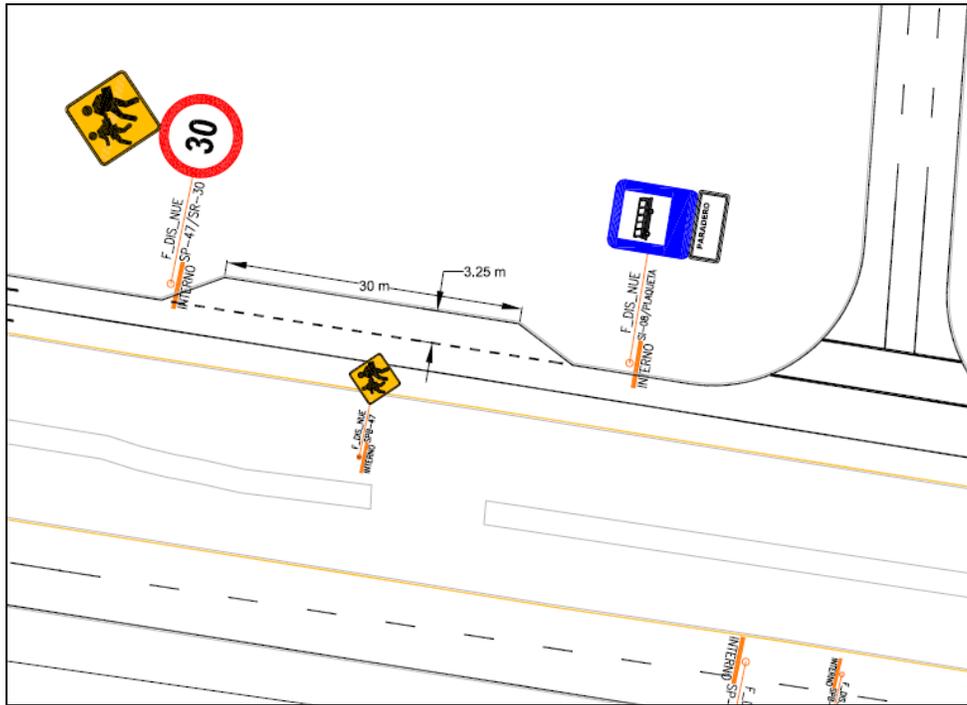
Detalle demarcación típica intersección interna del Plan Parcial
